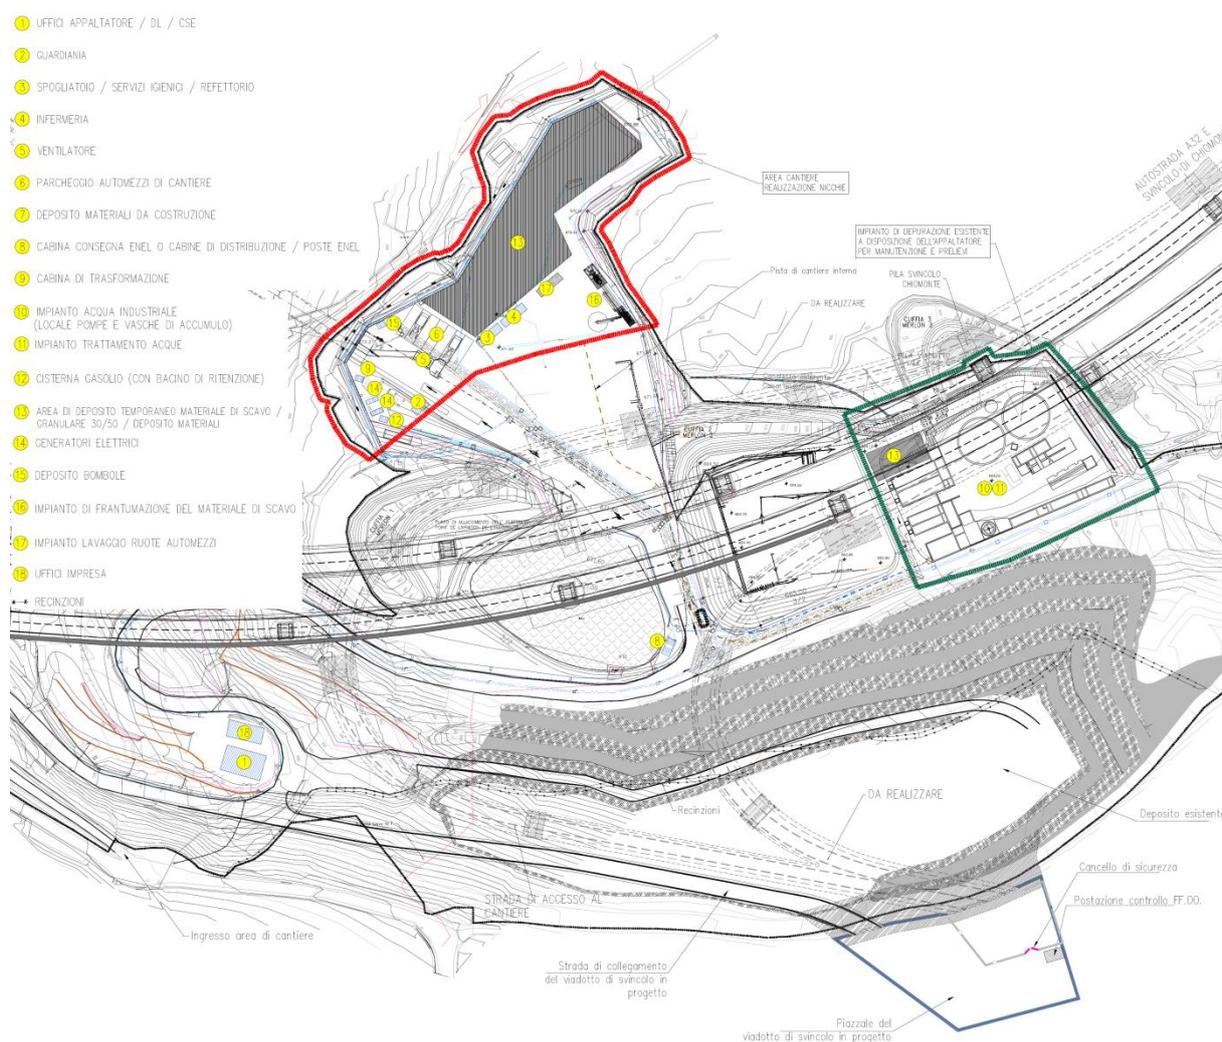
Planimetria cantiere in corrispondenza dell'imbocco
